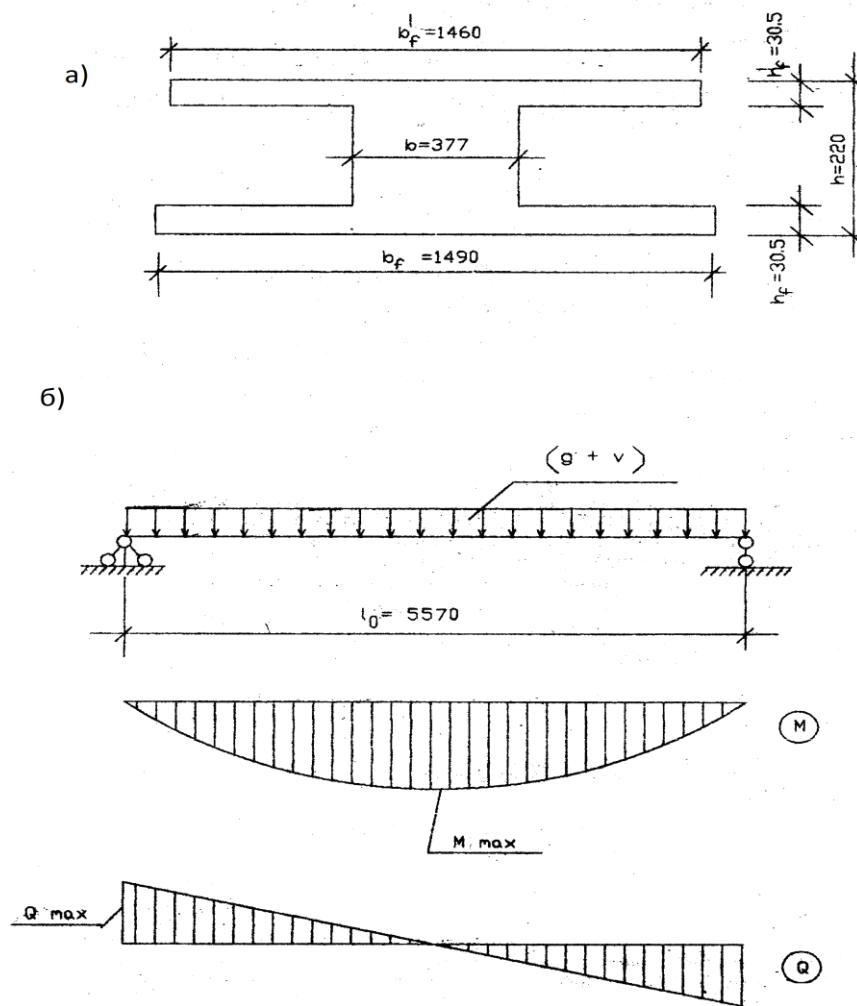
а) расчетное сечение плиты; б) расчетная схема и эпюры усилий
